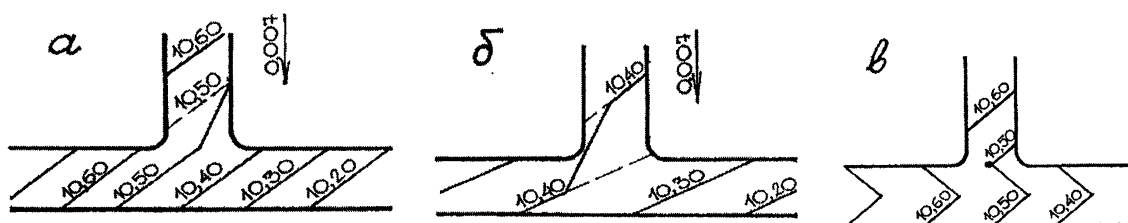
Схемы проектных горизонталей на примыканиях проездов.
